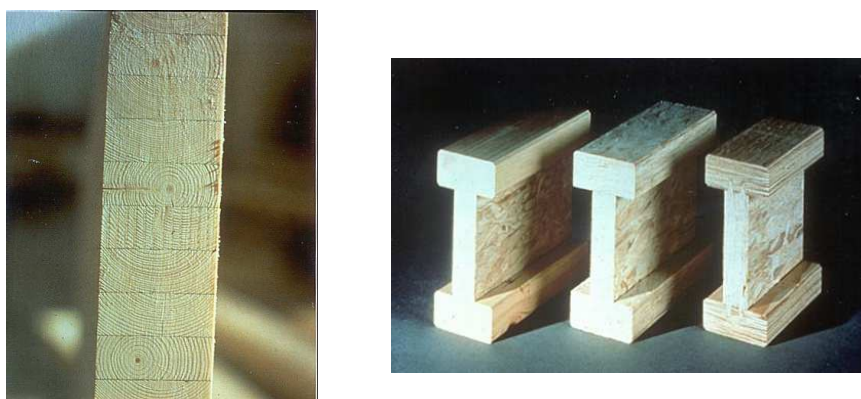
Madeira lamelada colada e Viga pré-fabricada à base de LVL e OSB
